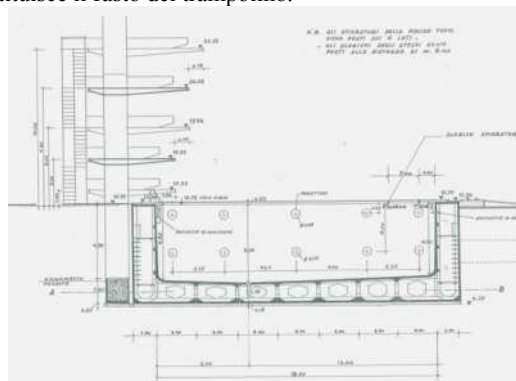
Sezione di progetto della piscina tuffi e del trampolino
